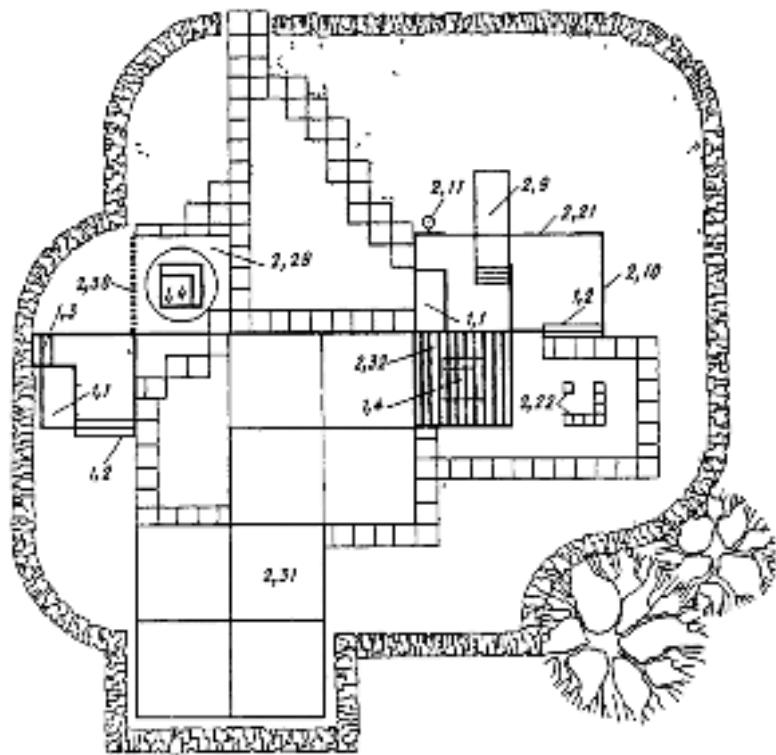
Планировка игровой площадки ясельной группы (2-3 года) (ЦНИИЭП учебных зданий)
